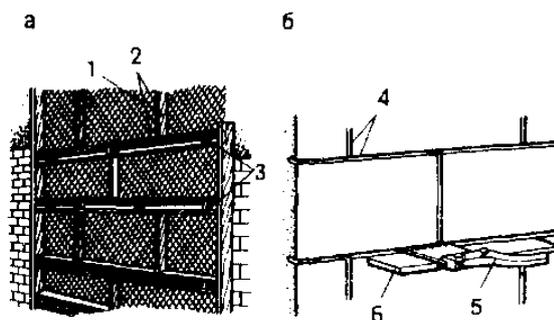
Расшивка рустов : а - рейками; б - наградкой;
